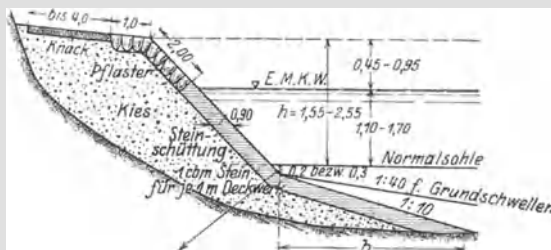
Bauart des Deckwerks der Weserregulierung.
